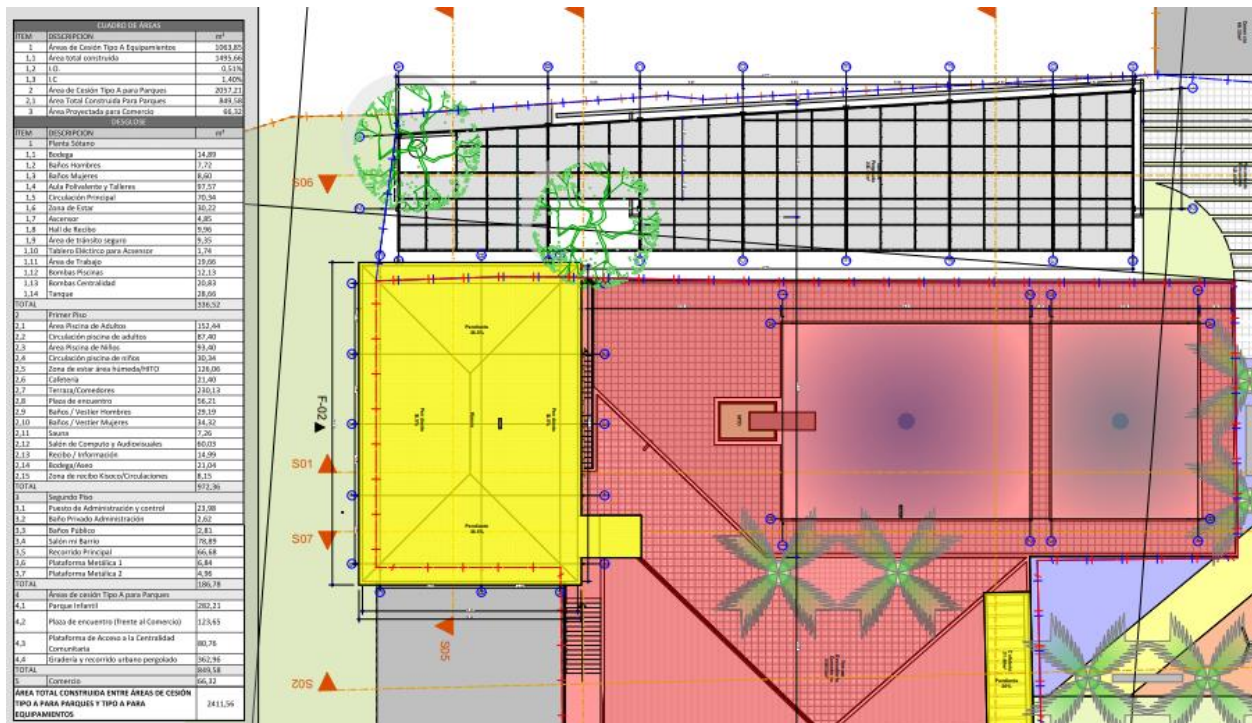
Planta General – Norte club tiburones – Fuente Constructora Sueños Reales S.A.S.
